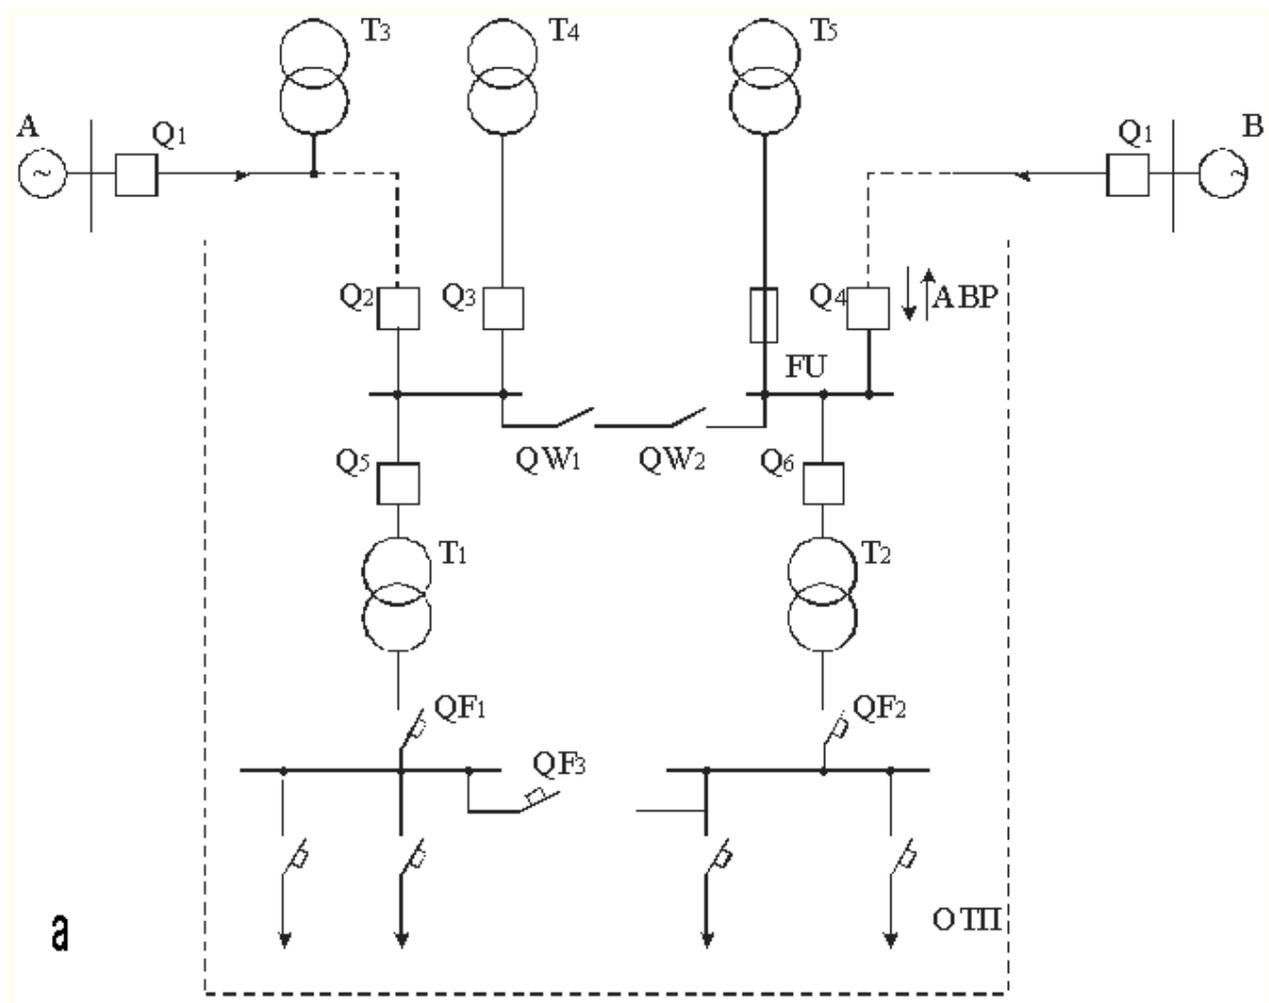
Схема электроснабжения ОС с. Стремилово
